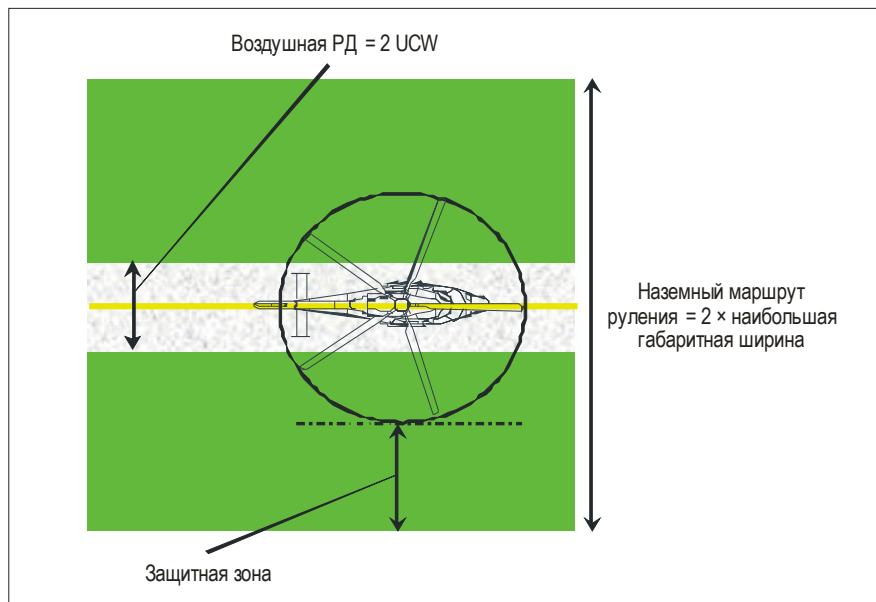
Воздушный маршрут руления/РД для вертолетов
